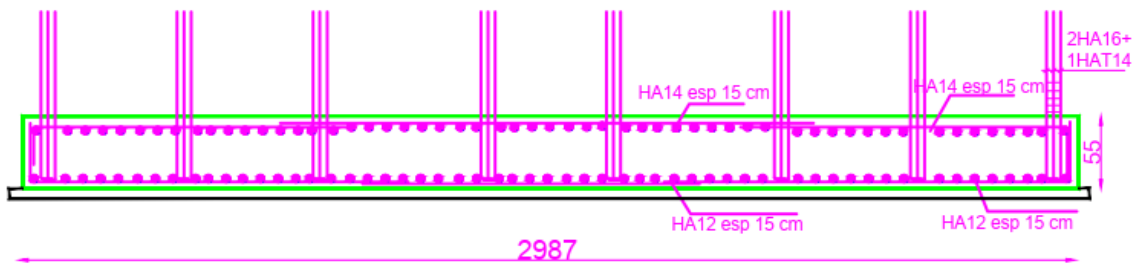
Plans de Coffrage et Ferrailage du Radier generale
